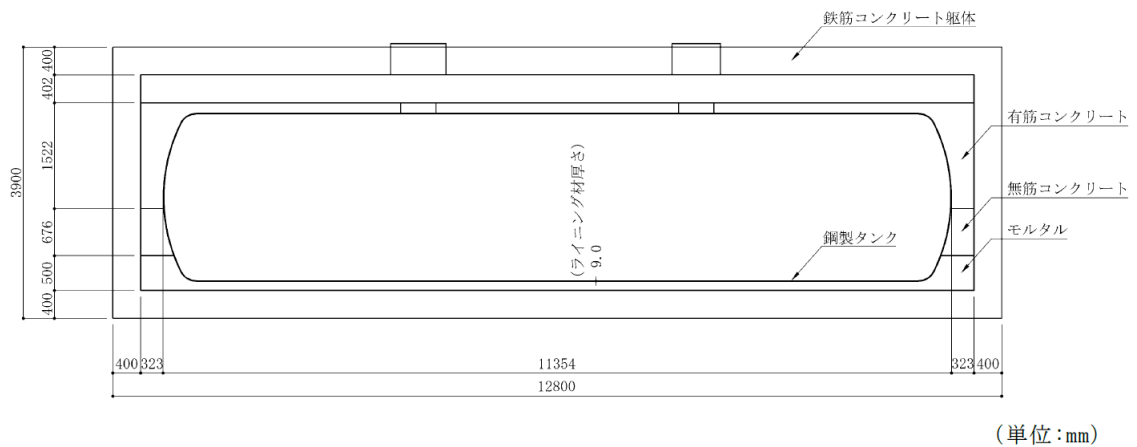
緊急時対策所用燃料地下タンク 断面図 (B-B断面)
